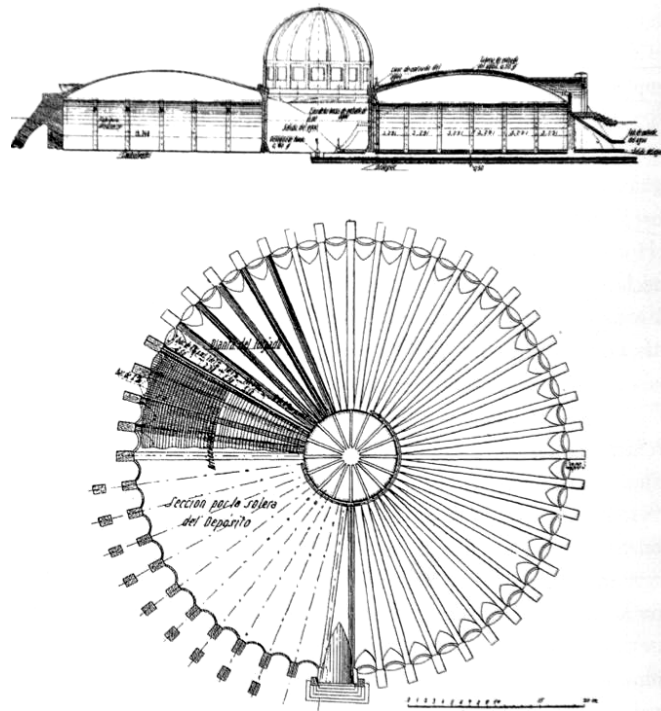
Estructura del cuarto depósito de aguas de Oviedo, 1929. Sección transversal y planta de la cubierta. Ildefonso Sánchez del Río, ingeniero de Caminos.
